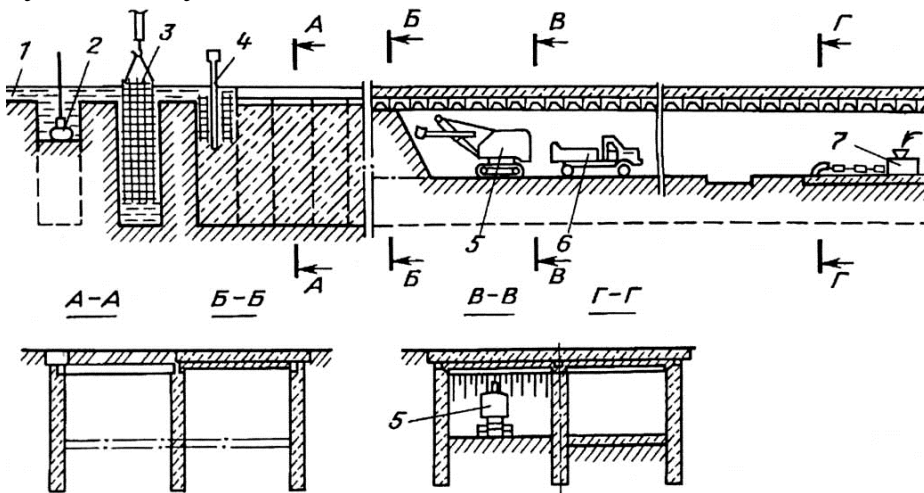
Схема будівництва тунелю траншейним способом:
